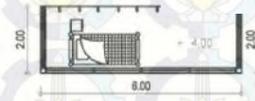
12 denah dan potongan bangunan hotel A-A'
